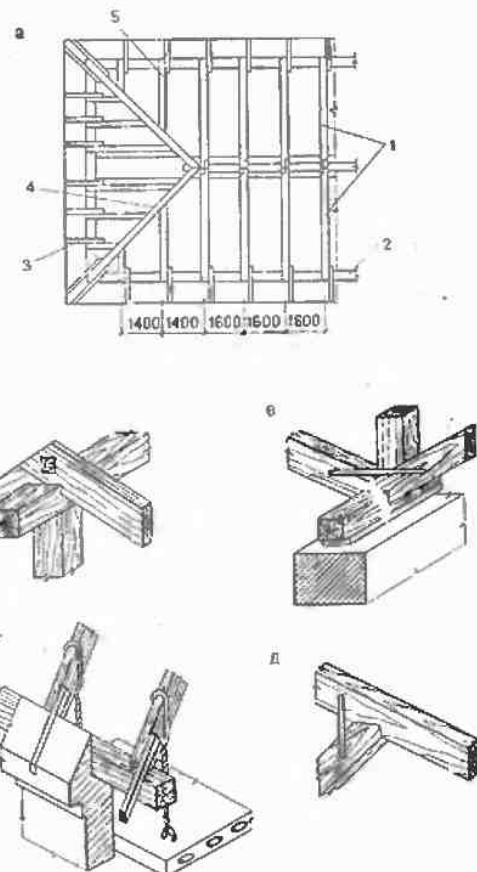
Фрагмент плана крыши и узлы наслонных стропил
